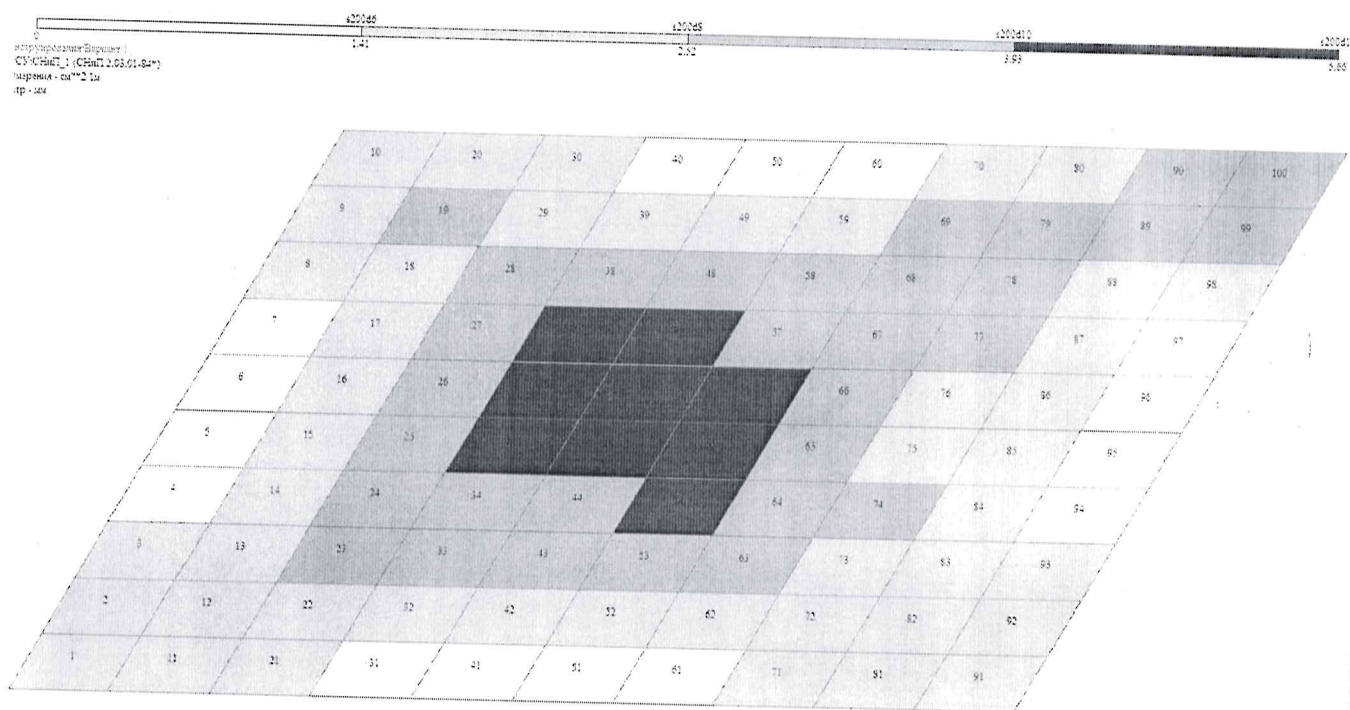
Площадь арматуры на 1 пог. м по оси Y по нижней грани
